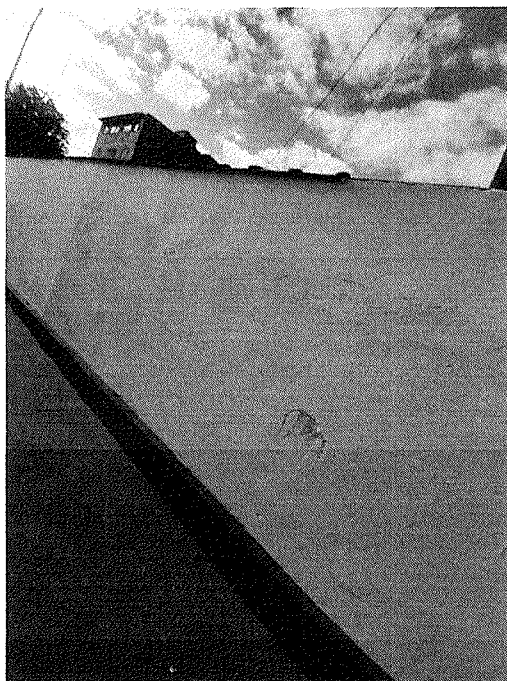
Tinta descascando e trincas pelo muro da parte externa da escola
